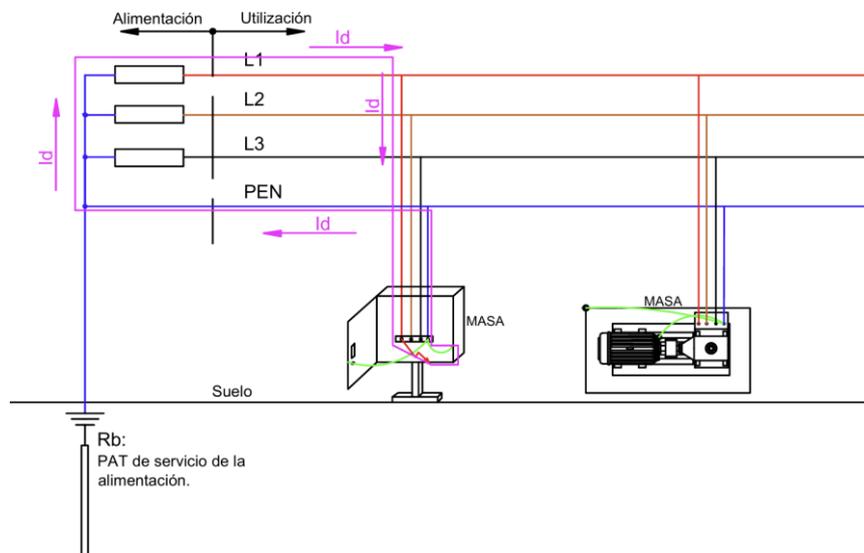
Instalación con ECT tipo TN-C bajo falla de aislación
